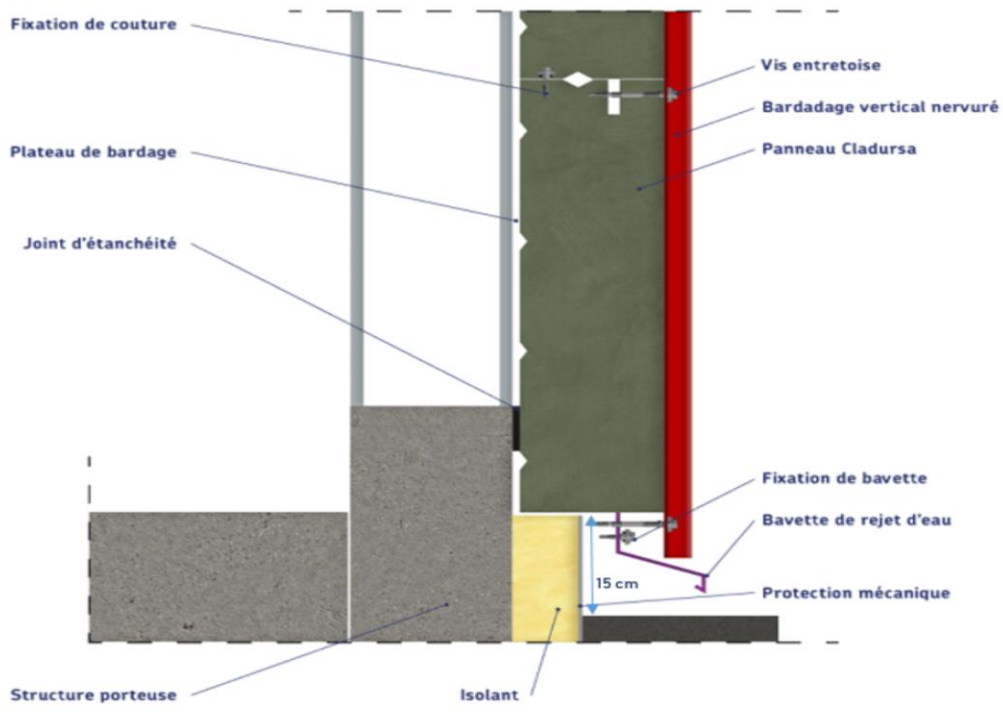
is – exemple de détail du pied de bardage sans ossature secondaire
